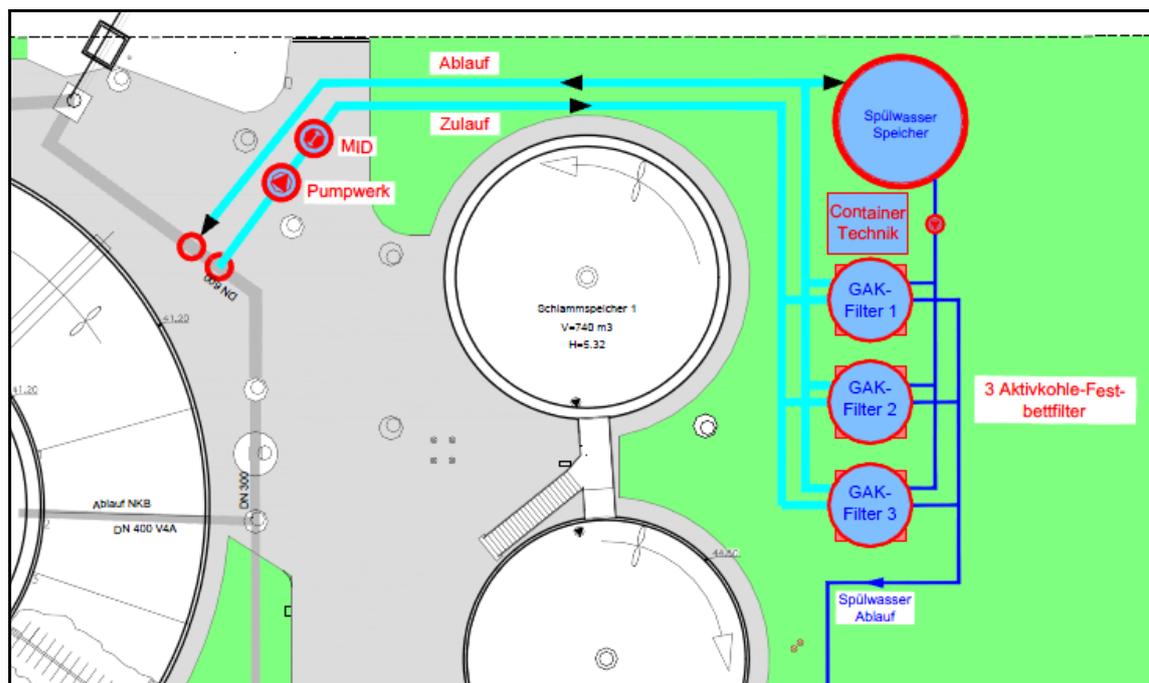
Lageplan KA Rahden - Variante 2.2 – GAK in Festbett-Adsorberstufe
